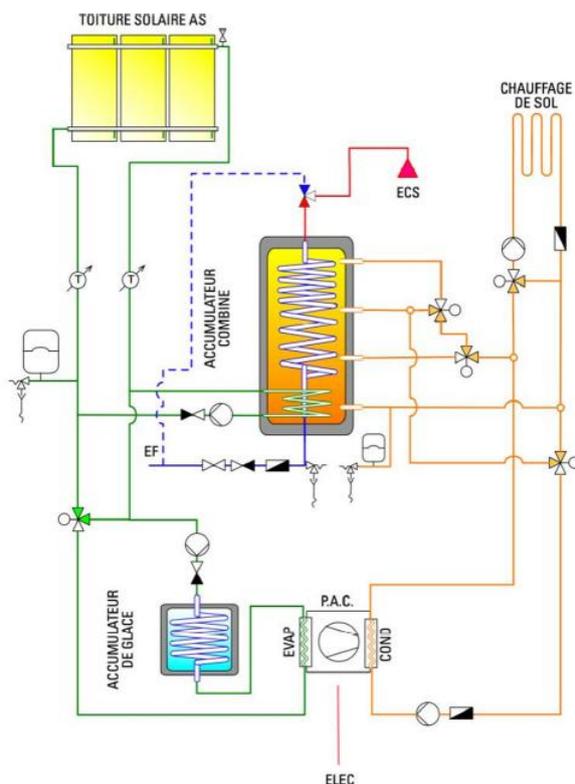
Schéma de principe d'une installation avec panneaux solaires, PAC eau/eau et stockage de glace
